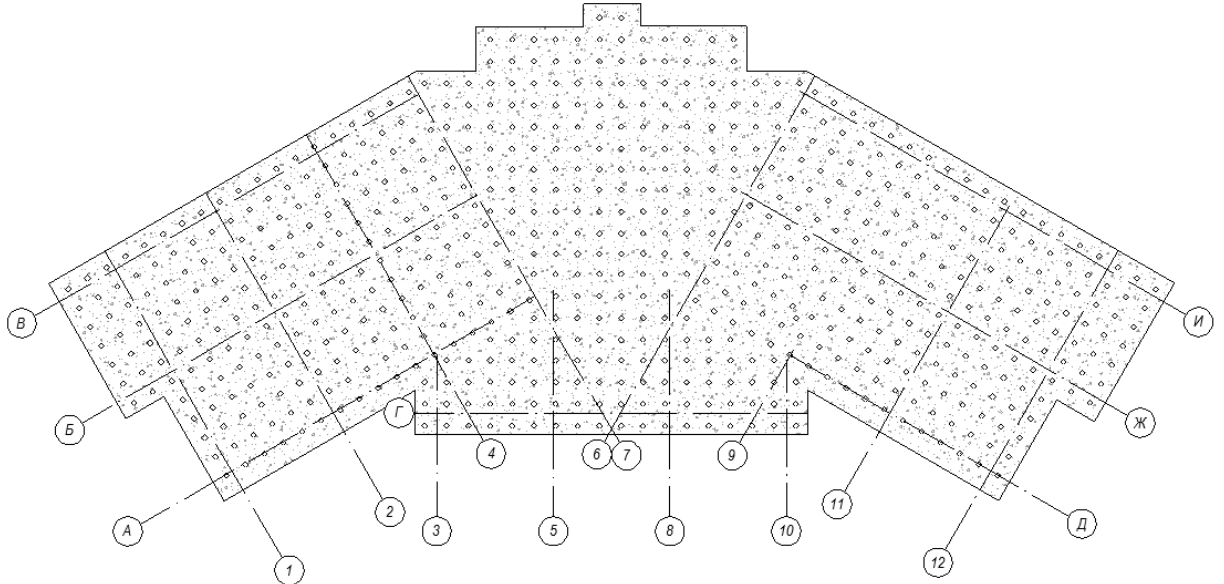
Опалубочный чертеж монолитной плиты фундамента с буронабивными сваями
